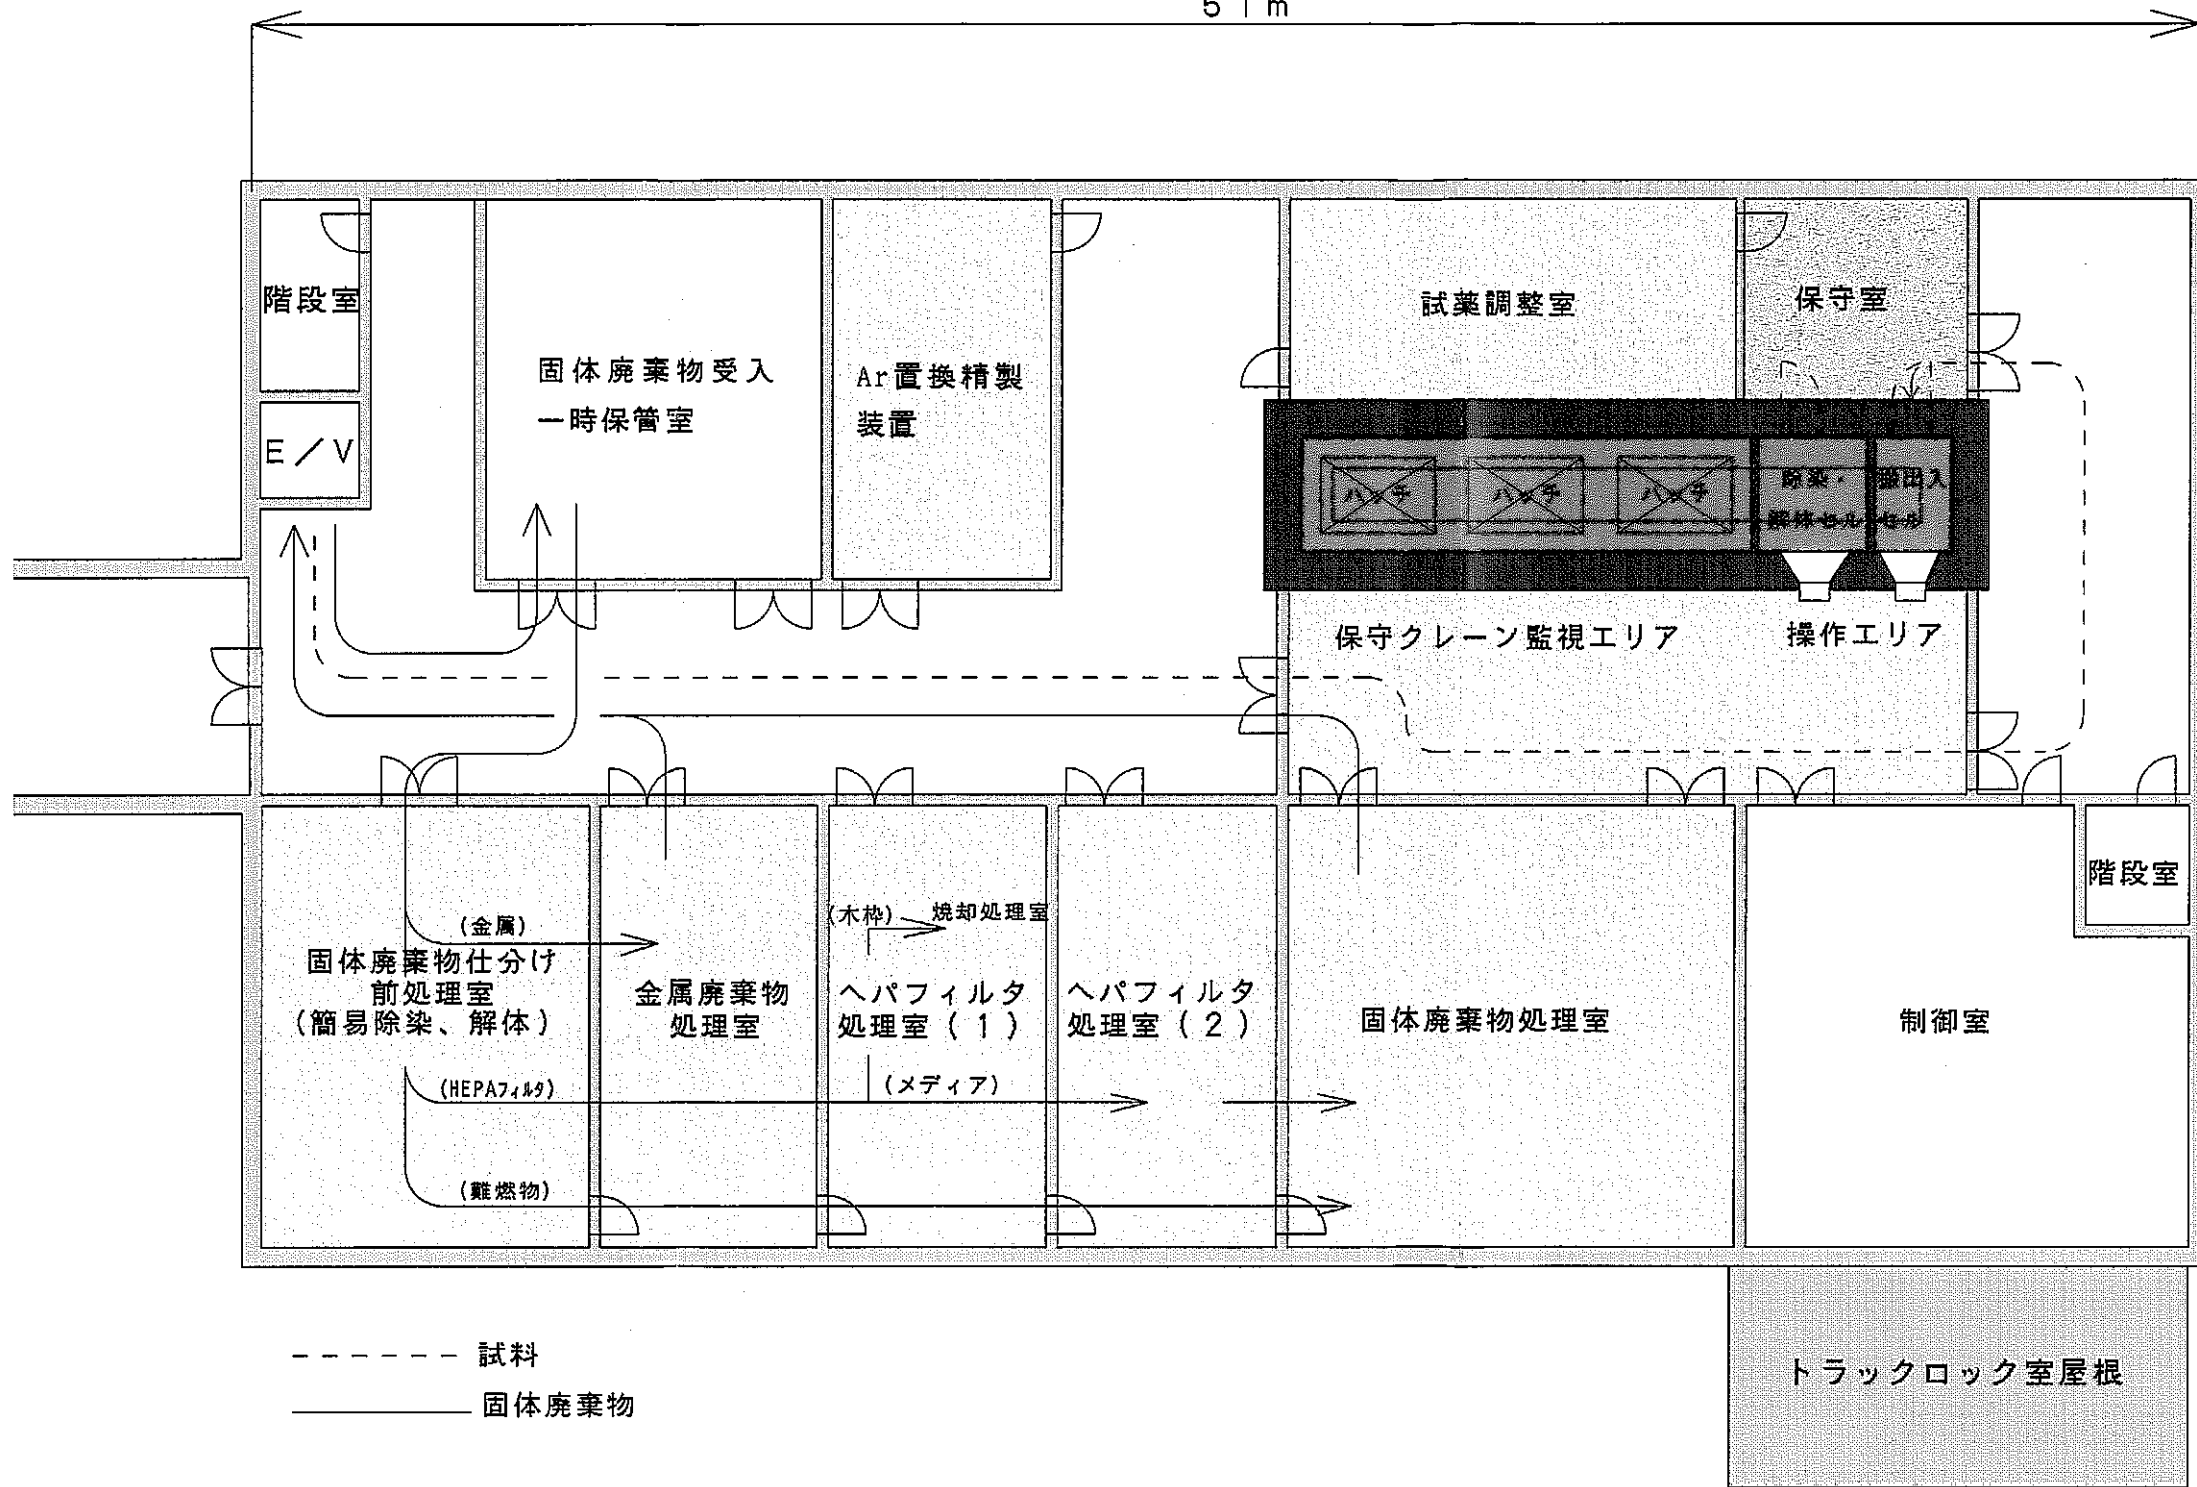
廃棄物処理・加処理研究施設 建屋内配置計画図 (2階)
